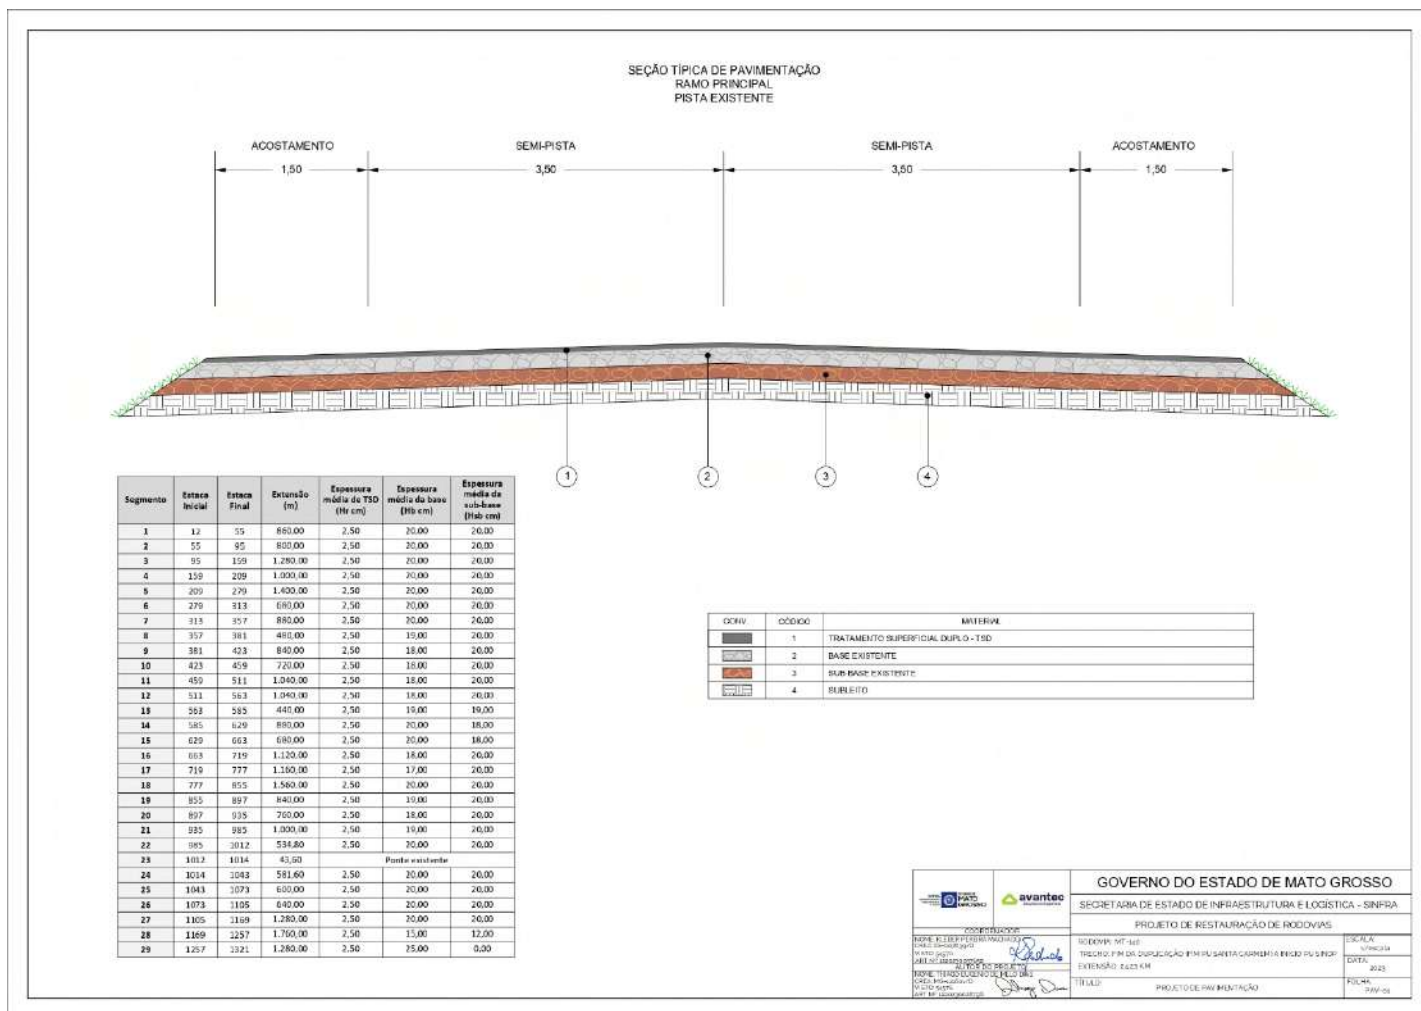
Seção Típica do Ramo Principal – Pavimento existente
